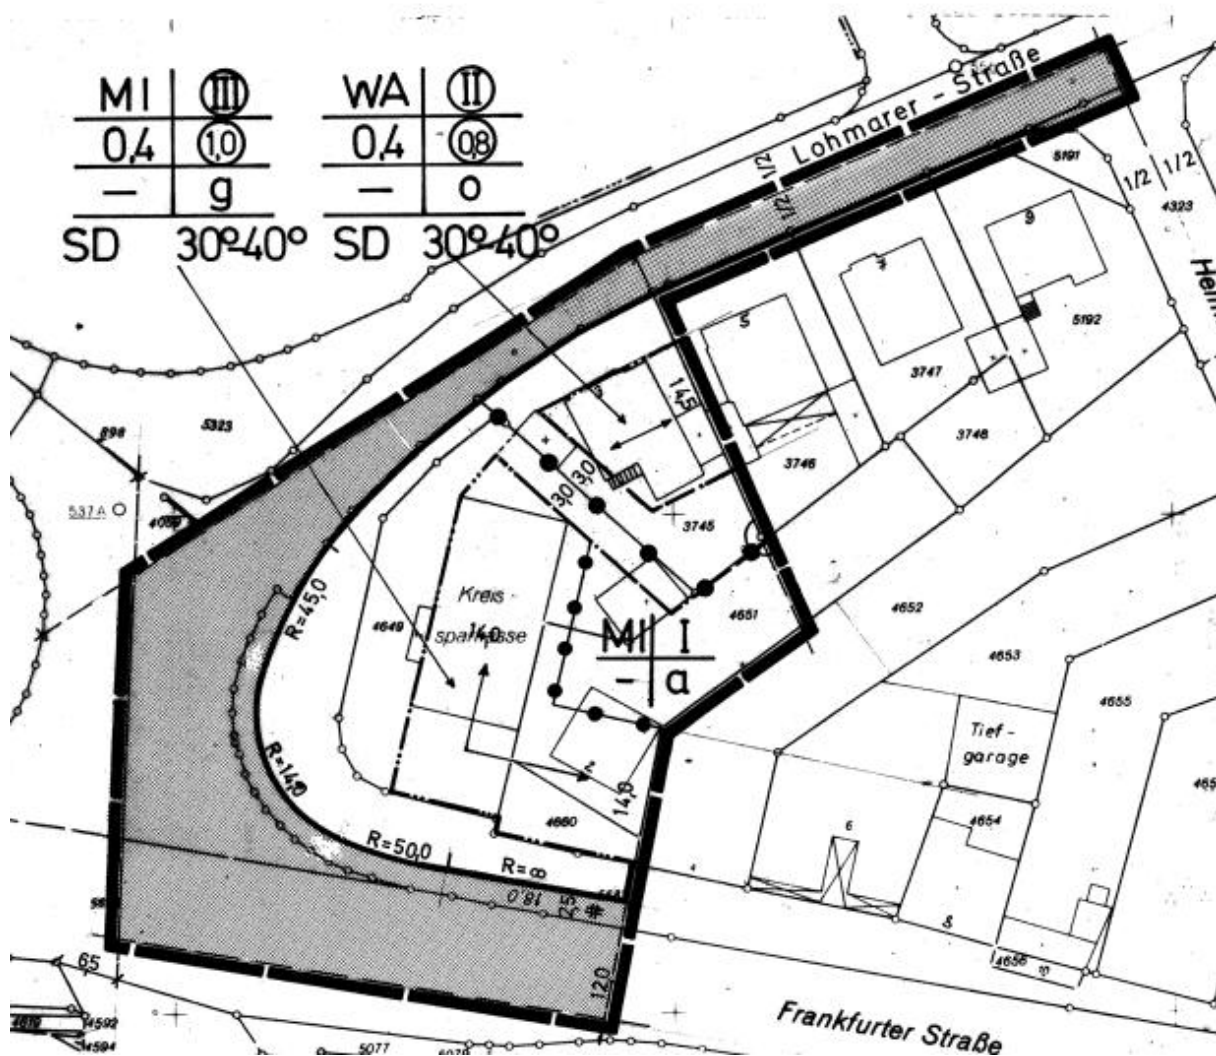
Rechtswirksamer Bebauungsplan T 1, 6. Änderung
